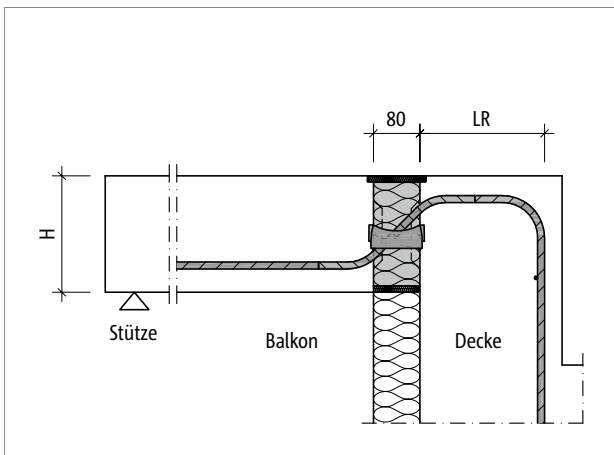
Schöck Isokorb® T Typ QL-WU: Balkon mit Höhenversatz nach oben und Außendämmung
